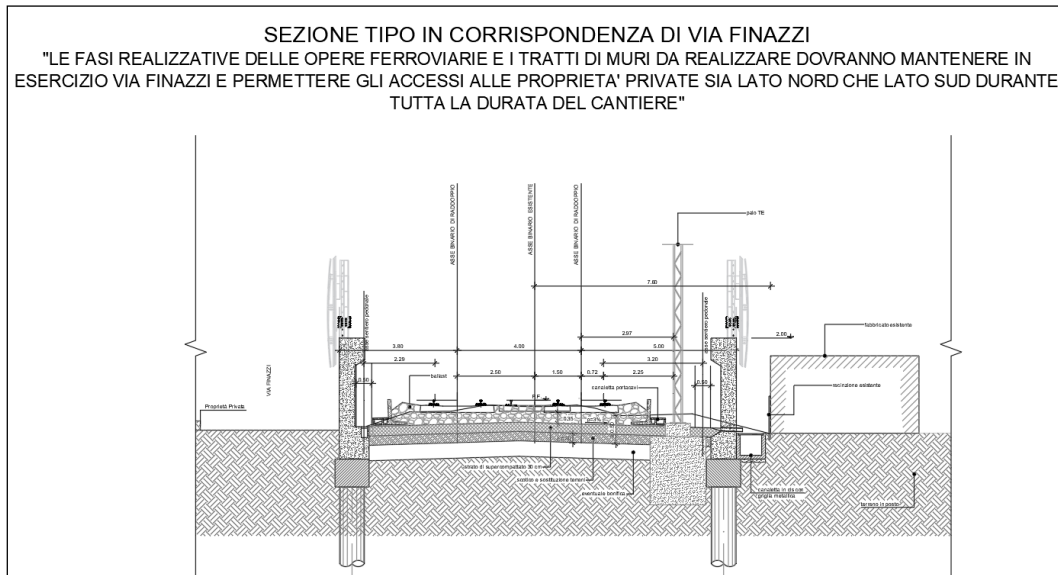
Sezione tipo ristretta in corrispondenza di via Finazzi
